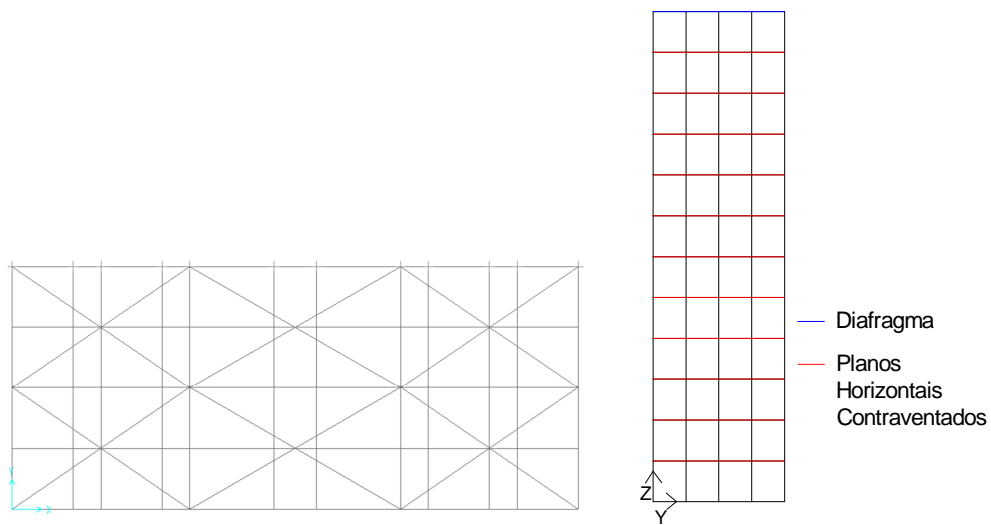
Configuração dos Planos de Contraventamento Horizontal Com Elementos de Contraventamento Grandes
